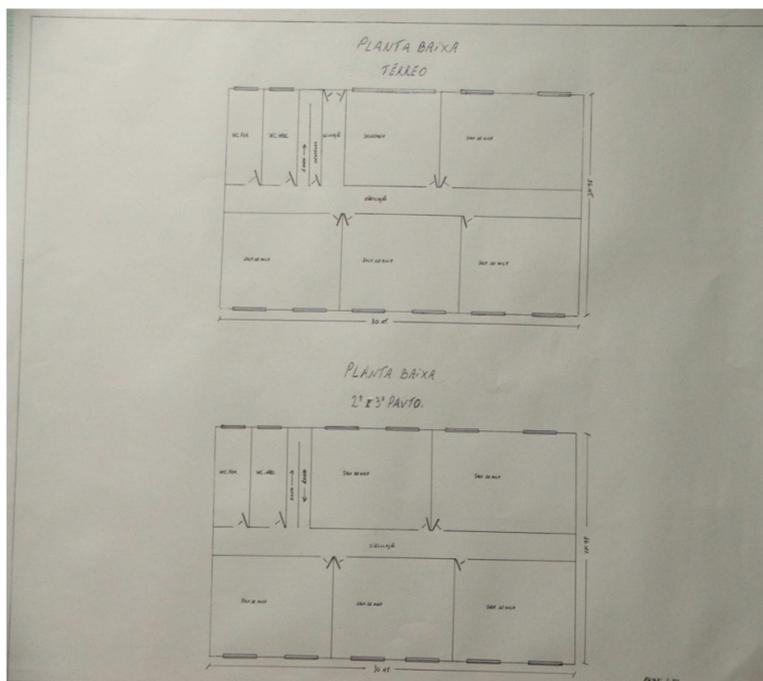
Foto da planta baixa desenvolvida pelo grupo G3
